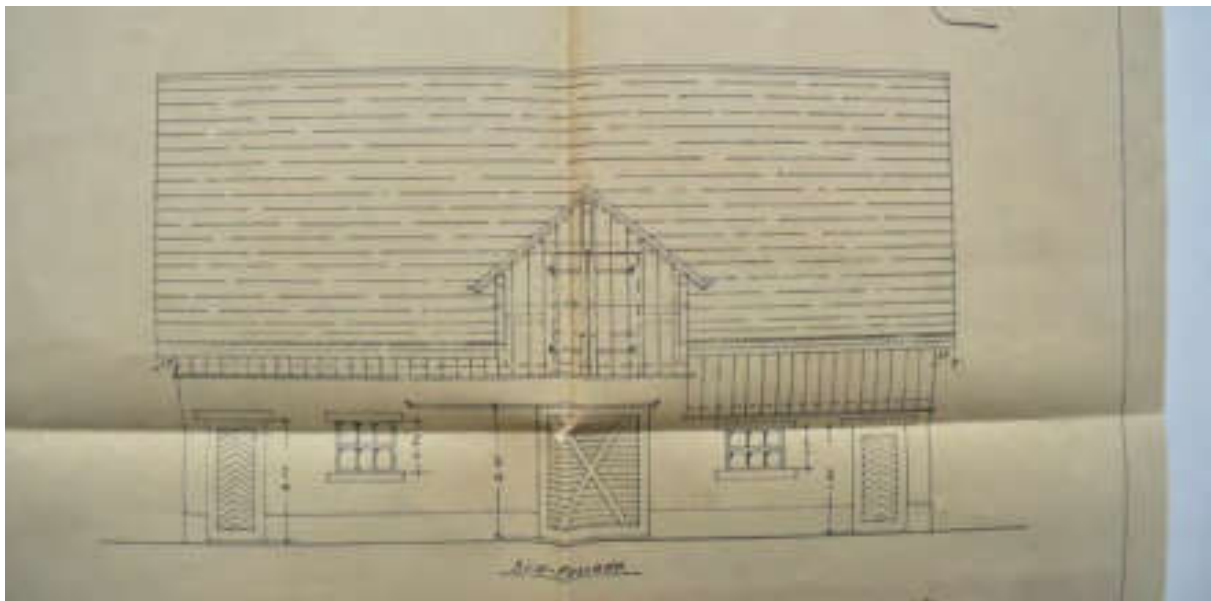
Baueingabeplan Ökonomiegebäude Assek.-Nr. 350, Südfassade 1:50, 25.09.1939, Markwalder Baubüro. Quelle: GdEA.
